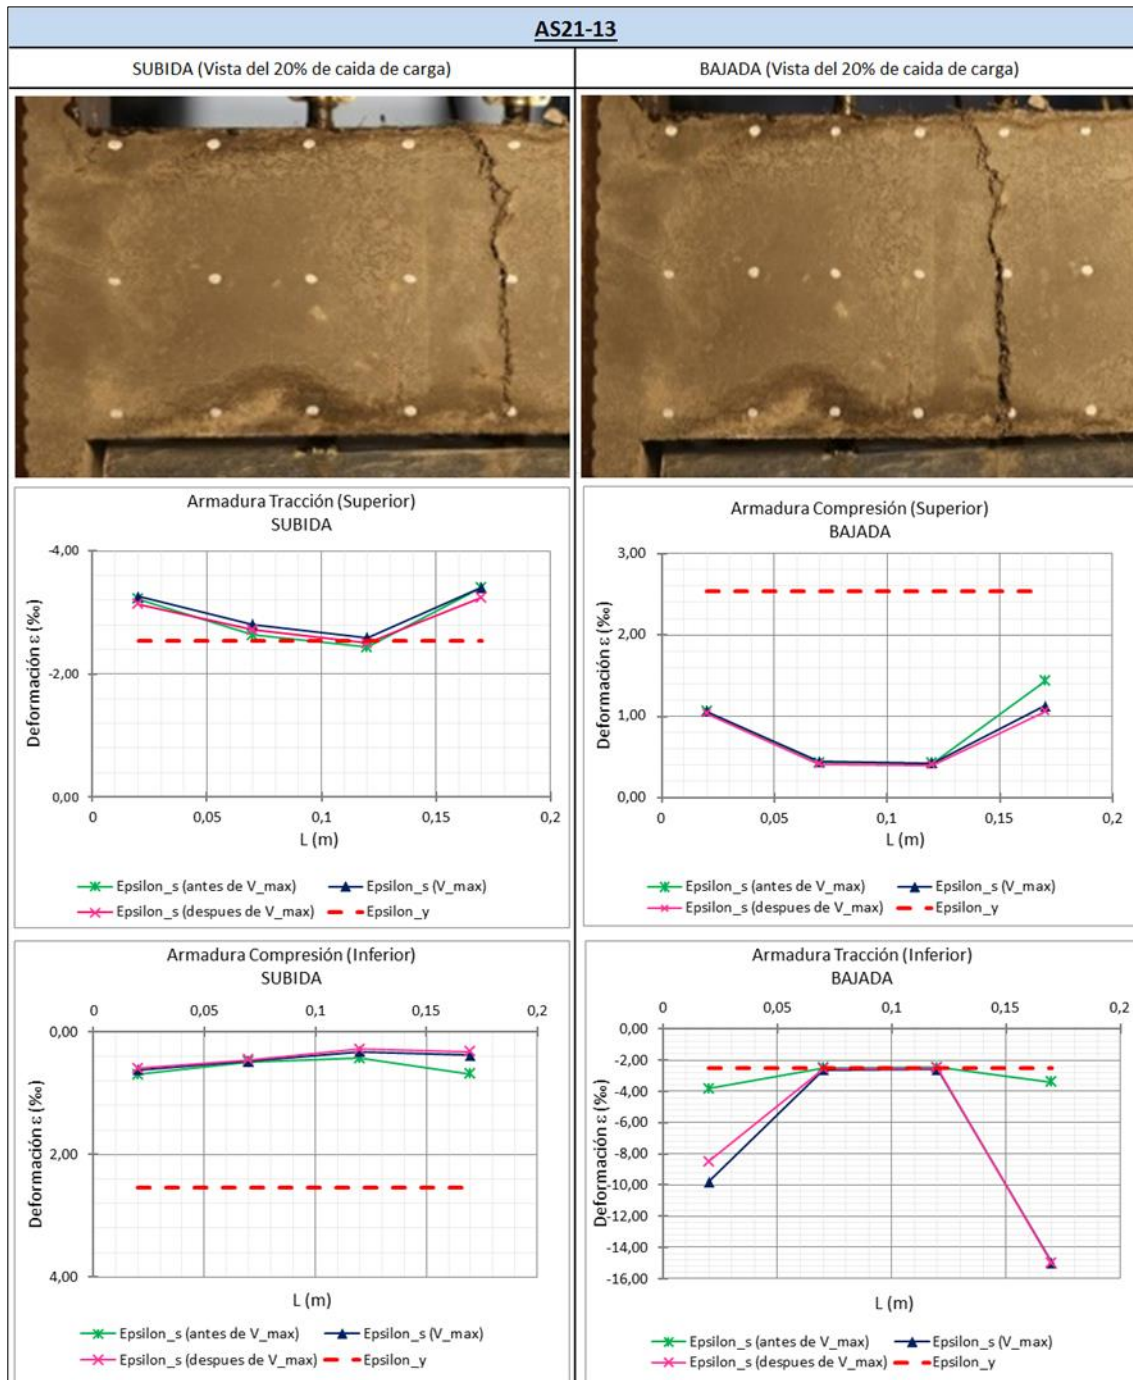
Perfiles de deformación en subida y bajada (AS21-13)
